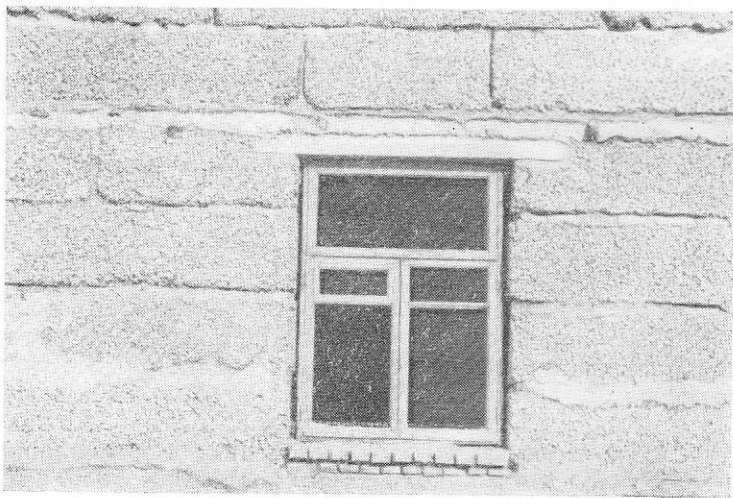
Антисейсмический пояс над оконными проемами в стенах из крупнопористого бетона
